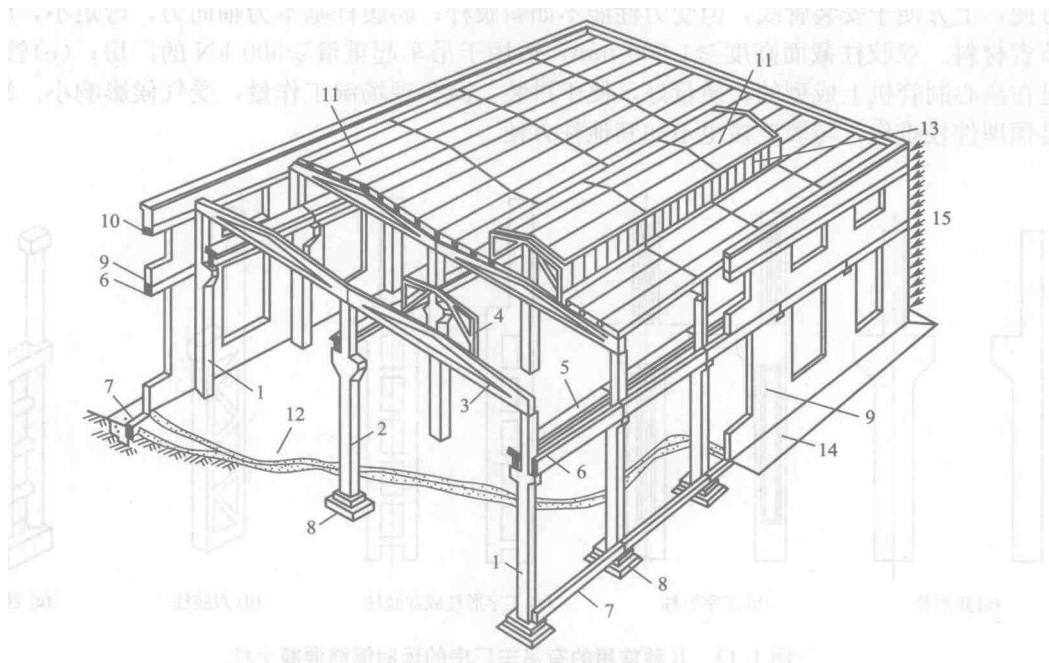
单层厂房装配式钢筋混凝土排架及主要构件
